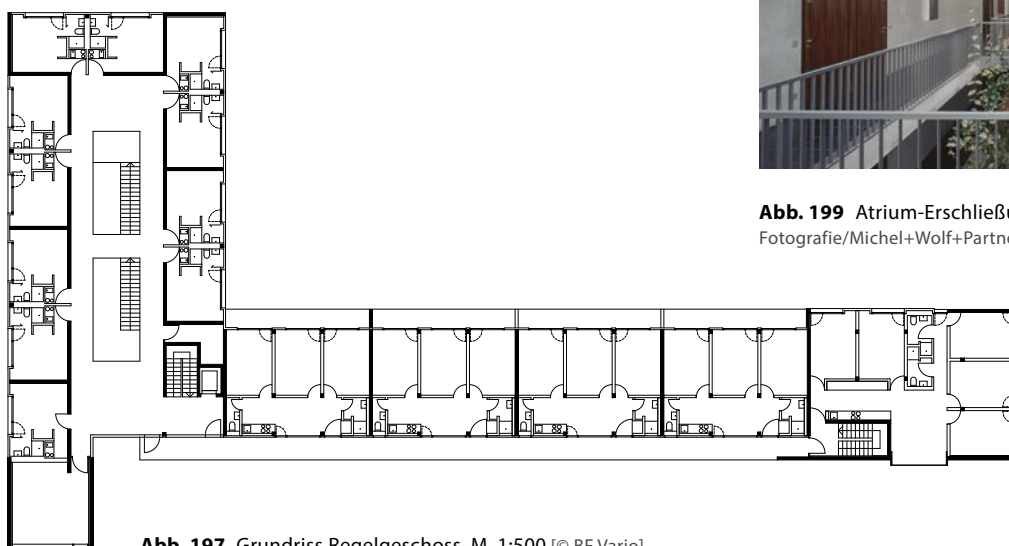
Grundriss Regelgeschoss, M. 1:500 [© BF Vario]
